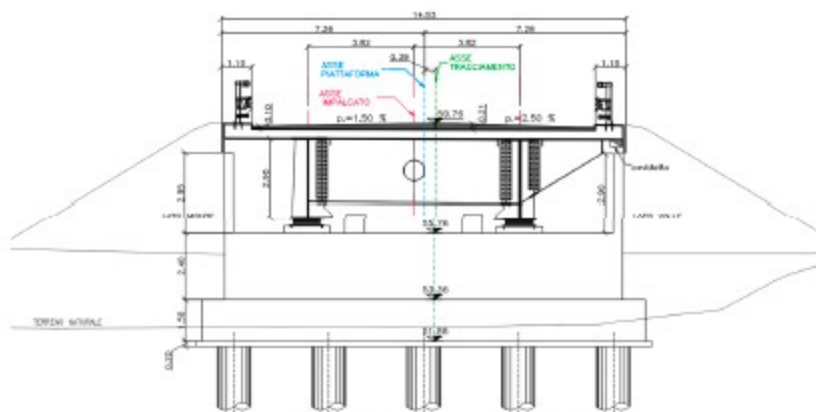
Sezione trasversale impalcato su spalla B
